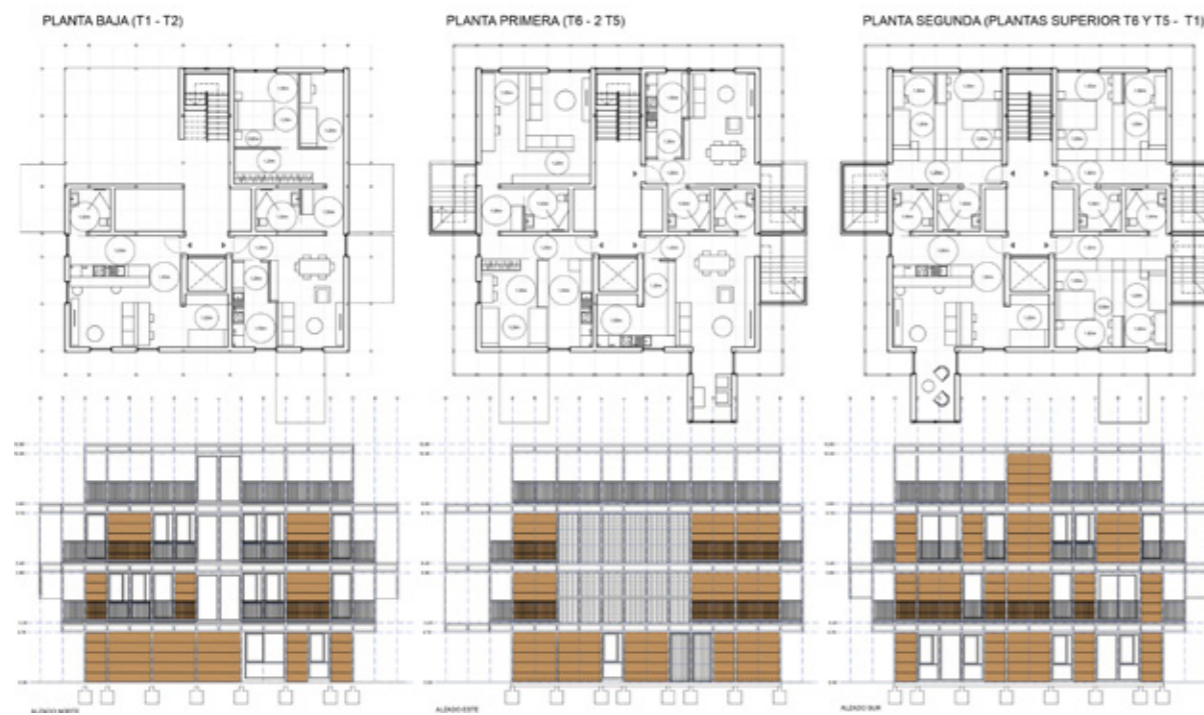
Plantas de las viviendas y modulación de alzados del prototipo empleado en la comprobación. Fuente: autores.
